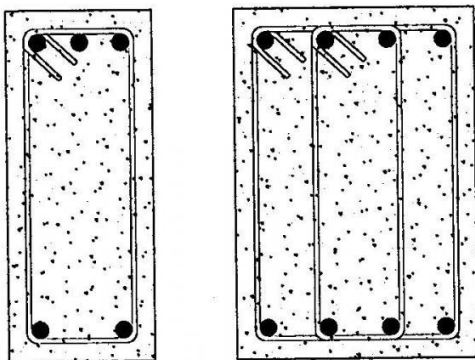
Construcción en Hacer (2016). Repaso de concreto reforzado
